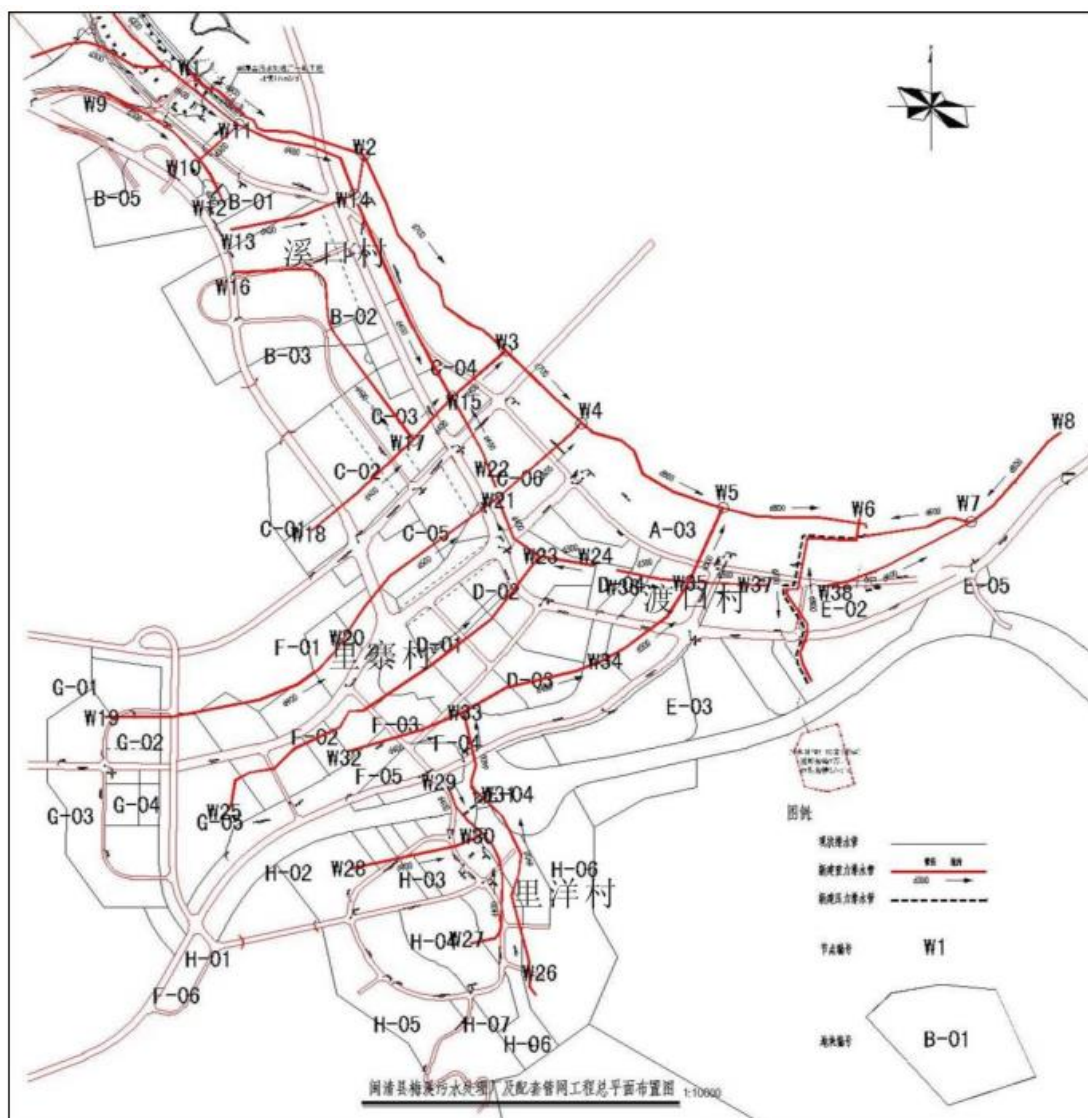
福清县梅溪污水处理厂及配套管网工程总平面布置图
